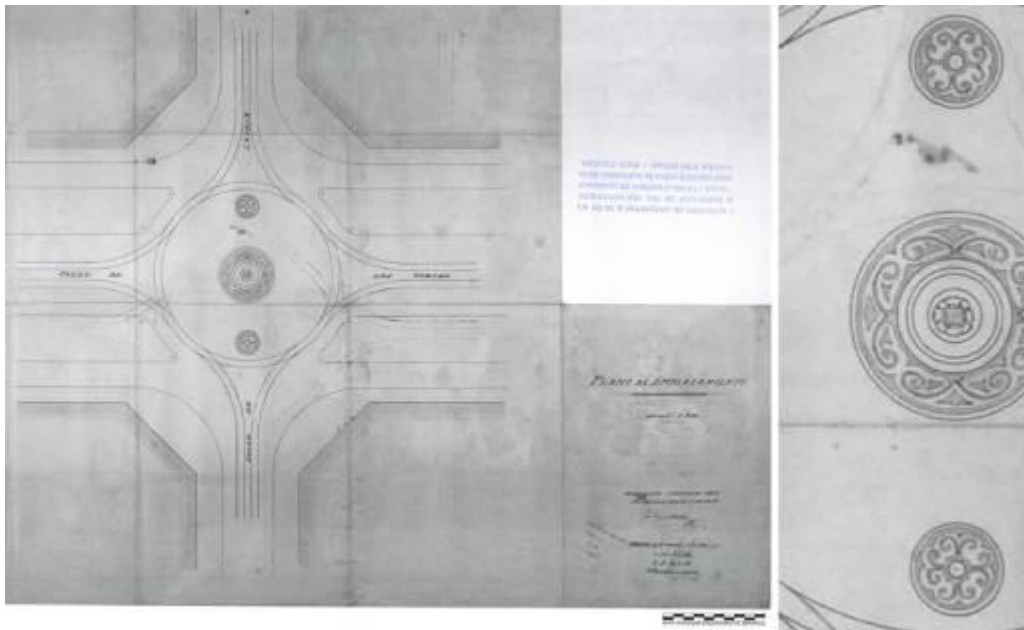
Plano Emplazamiento. Escala 1:200. Barcelona, Noviembre 1917. El Ingeniero Jefe de la Sección 6ª, Felipe Steva y Planas. (Fuente: Arxiu municipal administratiu de Barcelona. C29934 EXP 18166 AÑO 1910-1918)
